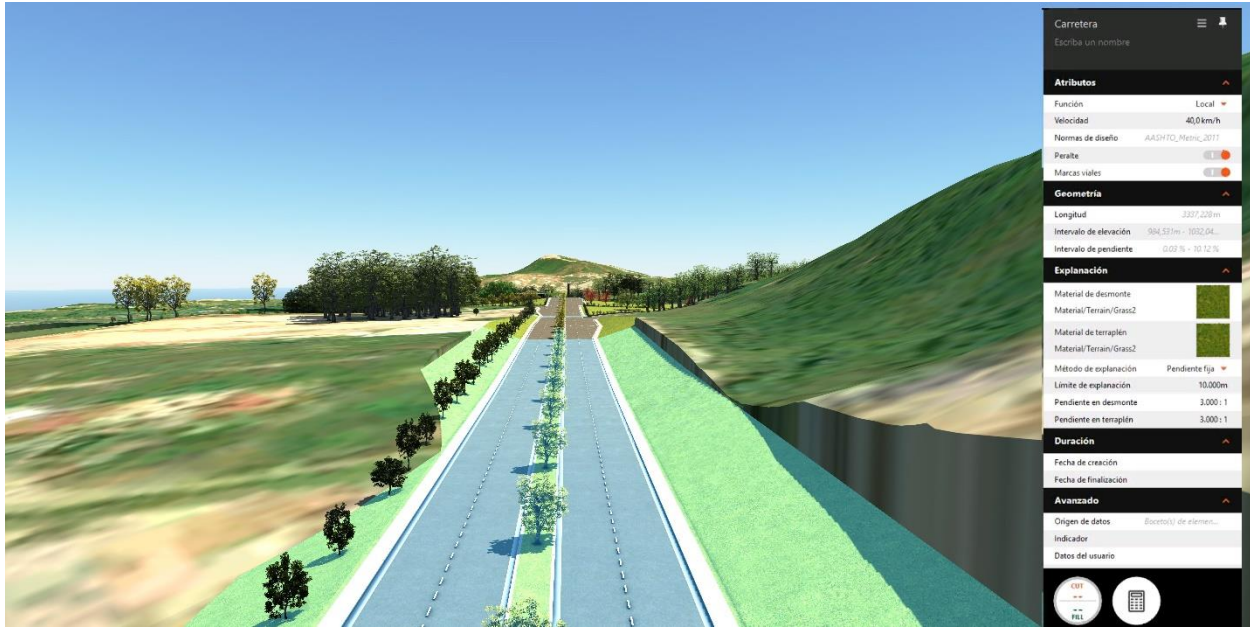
Tramo recto de la calzada principal para la disposición de la intersección tipo trompeta.
